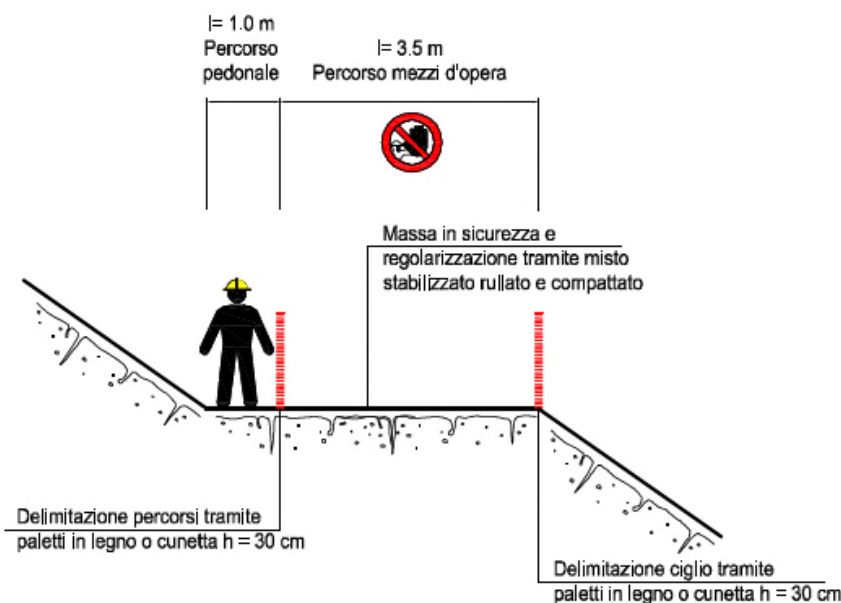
Sezione tipologica di una pista di accesso al fondo degli scavi
